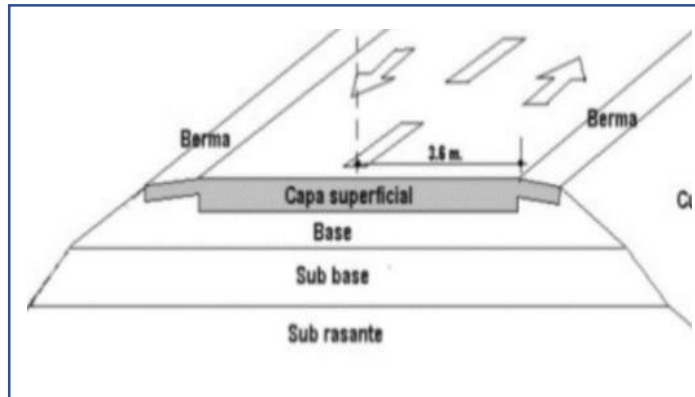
Estructura típica de un pavimento (Ingeniería & Construcción).
